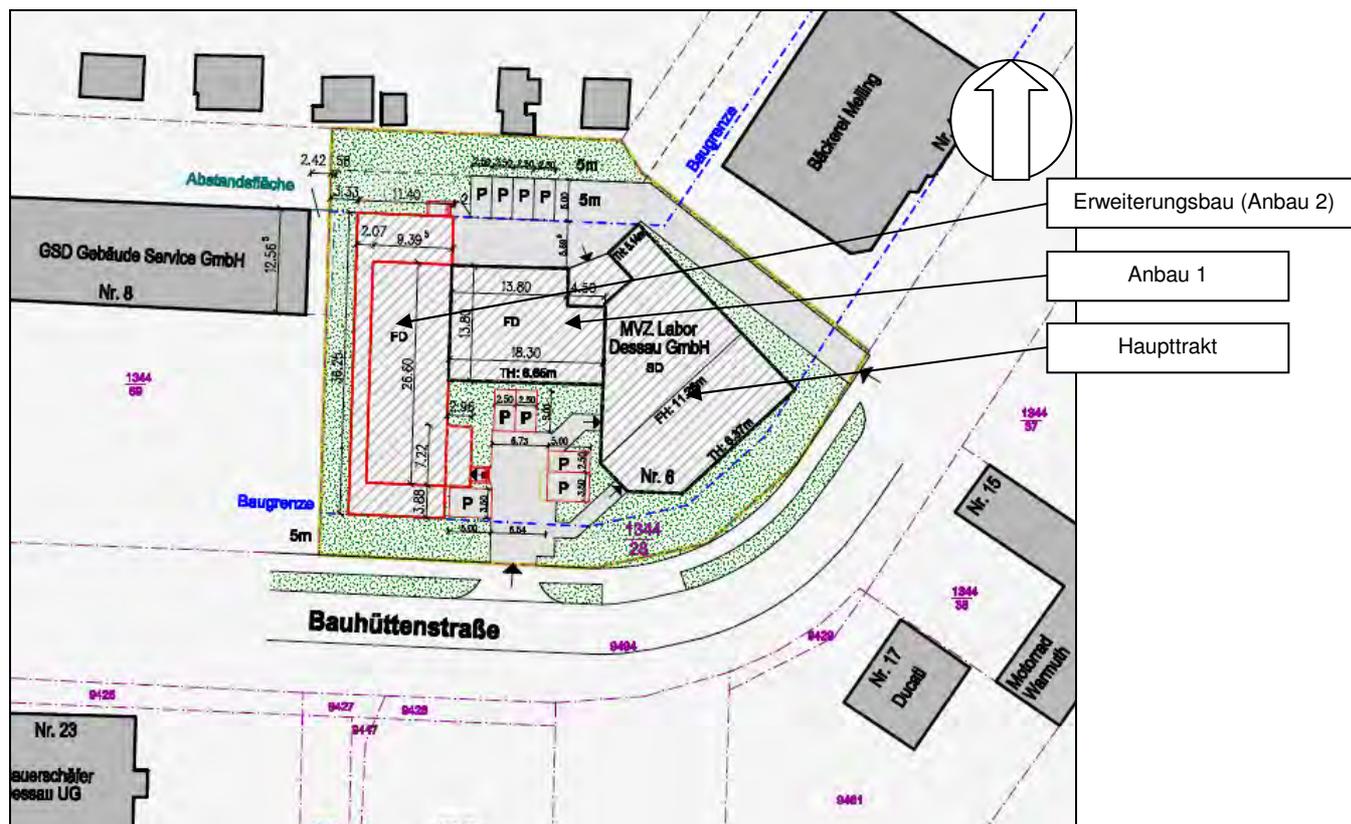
Lage- und Übersichtsplan zum geplanten Erweiterungsbau des Laborgebäudes Bauhüttenstraße Nr. 6. Vergleiche hierzu auch die Zeichnung-BI.-Nr. 0. (Entwurf und Zeichnung: RIK – Kathleen Gerth)
